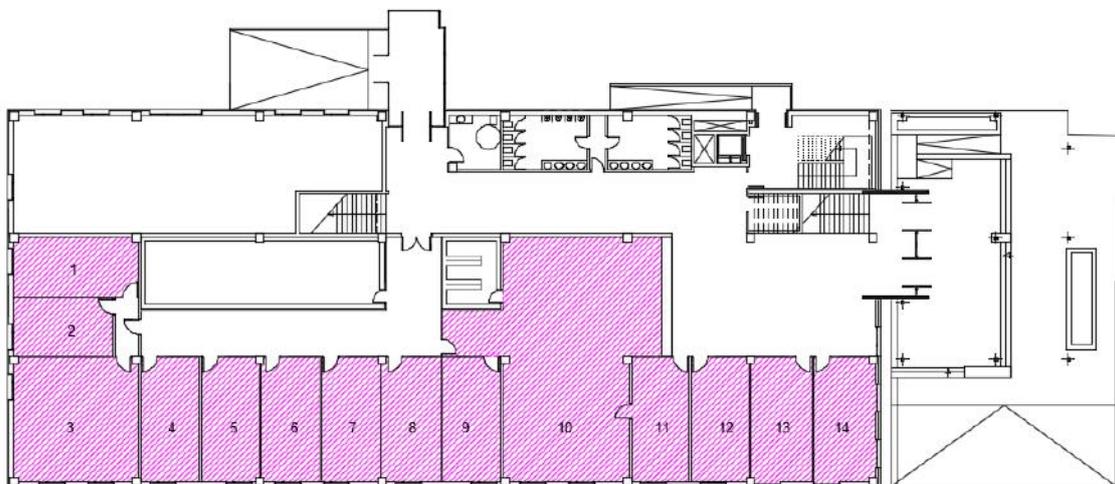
Situación Despachos de Administración-Dirección en Planta Baja. Figura extraída del plano 52.
